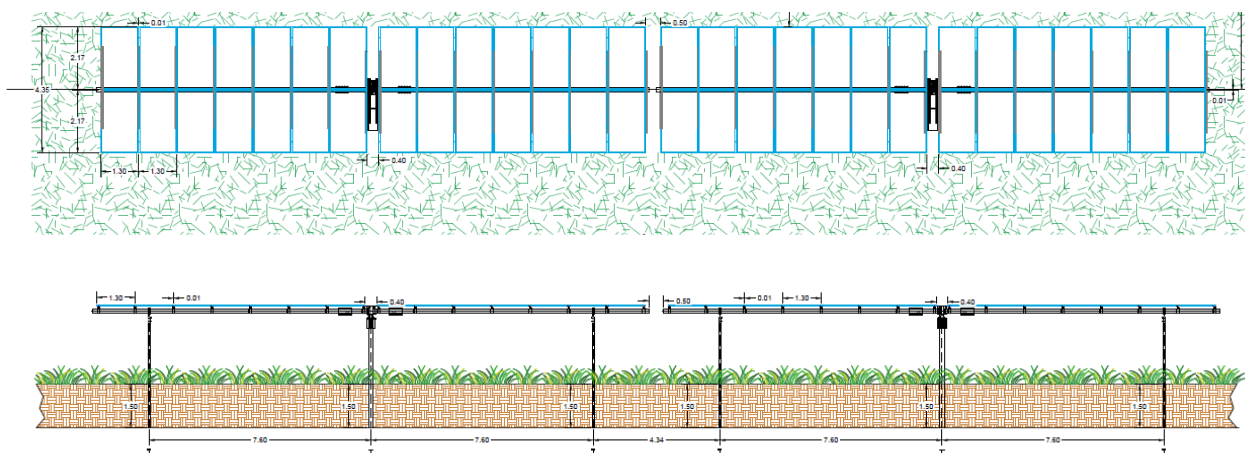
Vista in pianta e in sezione dei tracker con i moduli fotovoltaici
